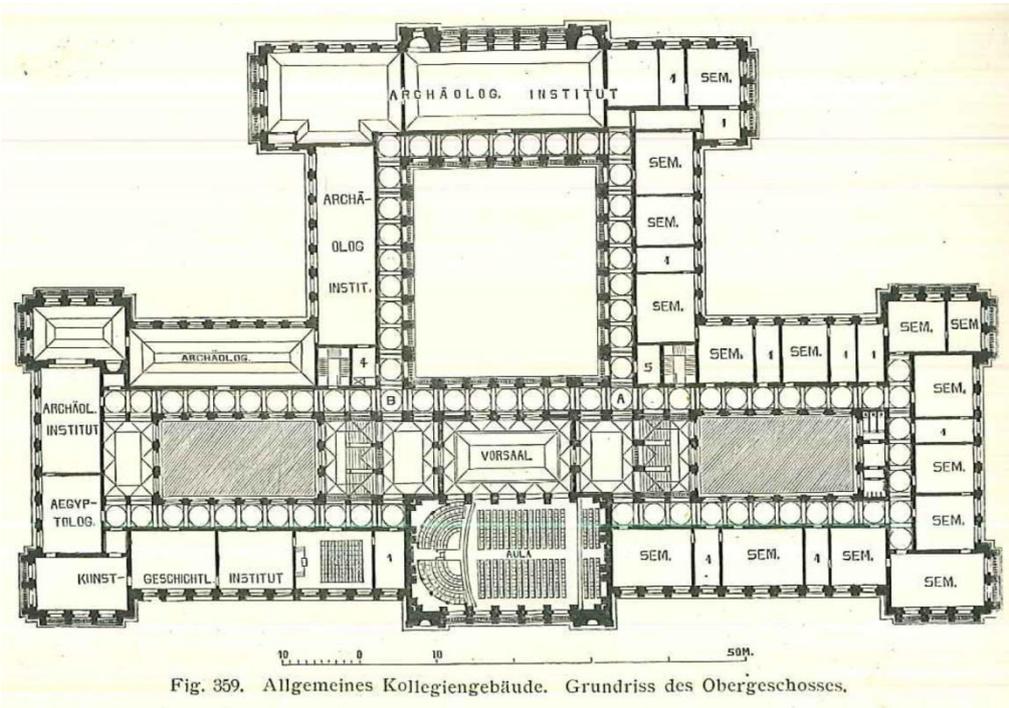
Allgemeines Kollegiengebäude. Grundriss des Obergeschosses.
